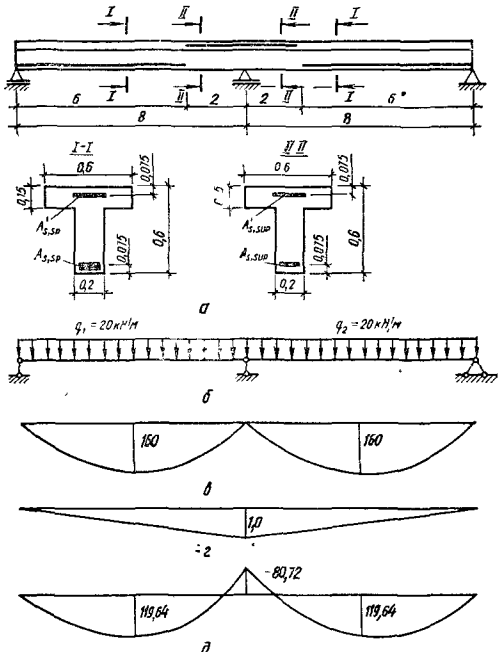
К примеру 6.6. Двухпролетная железобетонная балка (размеры в м):
